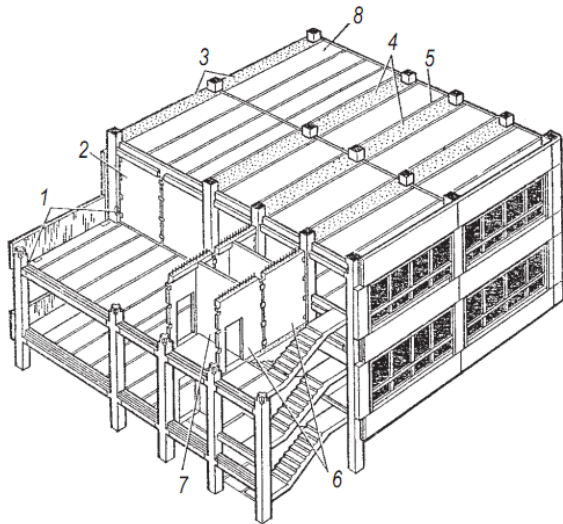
Елементи, які забезпечують жорсткість каркасно-панельної будівлі: 1 – спряження вузлів; 2 – стінки діафрагми жорсткості; 3 – пристінні плити; 4 – зв'язкові плити; 5 – замонолічені шви; 6 – стіни сходової клітки; 7 – стіни ліфтової шахти; 8 – рядова плита перекриття
